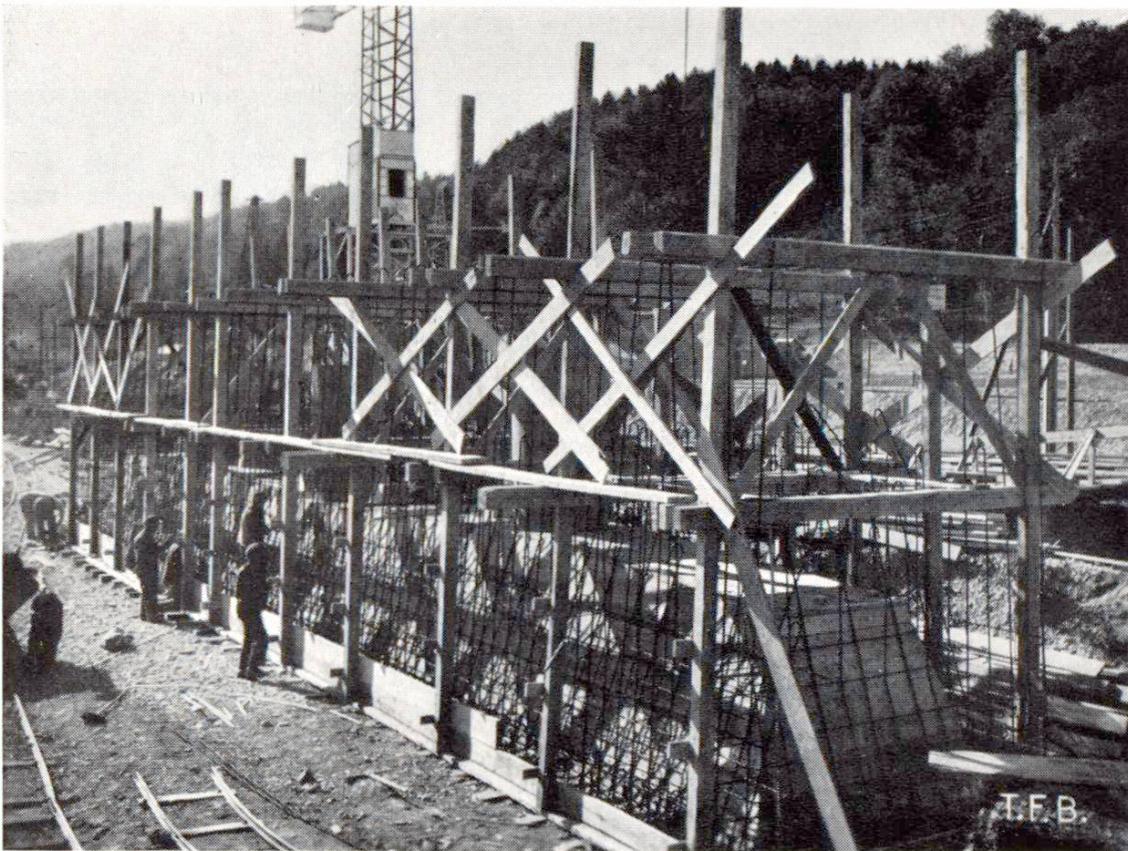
Construction d'un petit caisson en béton sur la rive gauche de l'Aar
